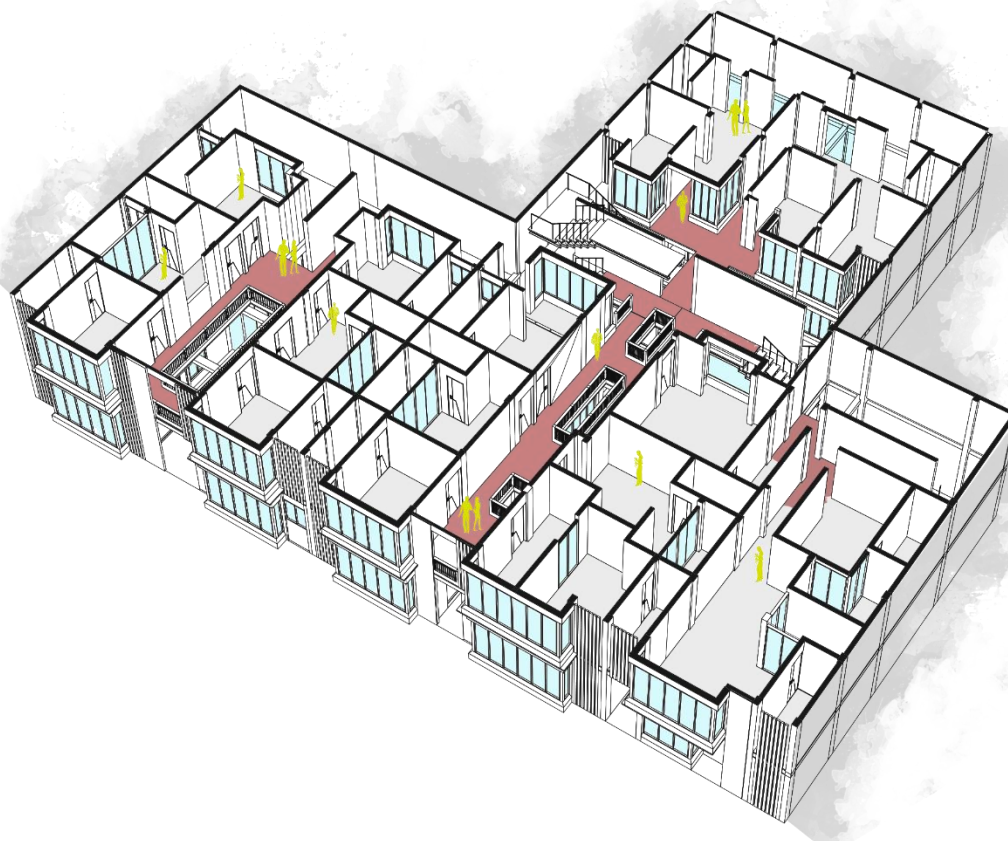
Bloque (B) de propuesta arquitectónica dentro del centro de manzana.
